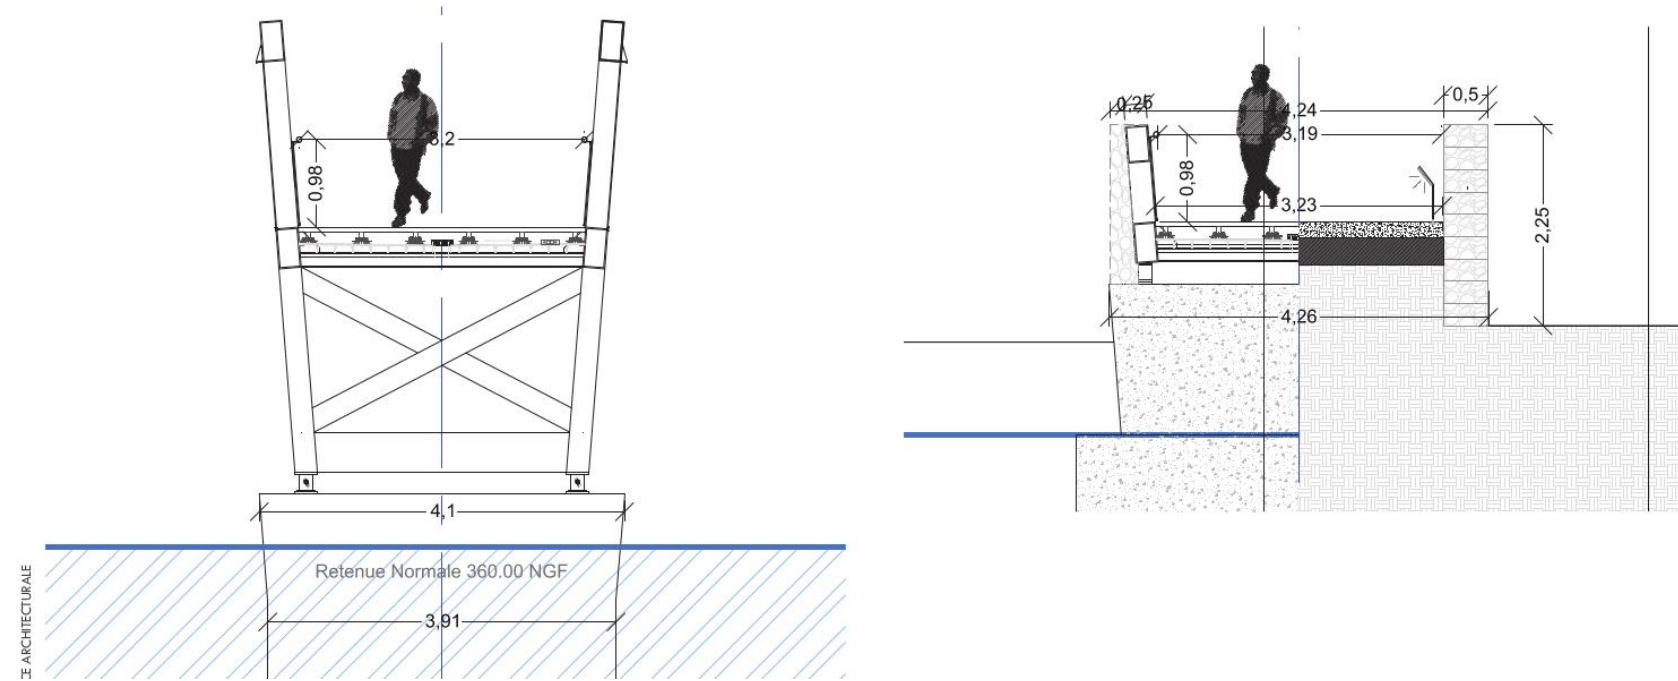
Coupe sur pile et sur culée C3 (sur ouvrage à droite et hors ouvrage à droite)
